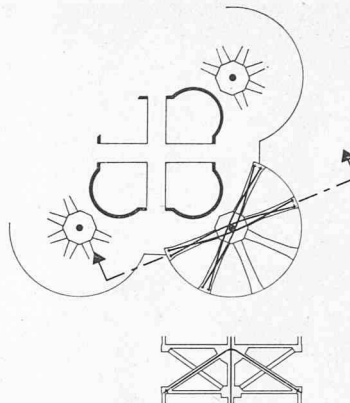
Technikgeschoss. Spannbewehrungsschema der Zugdiagonalen eines Grundrisskreises, die ein «Gegenüber» haben
